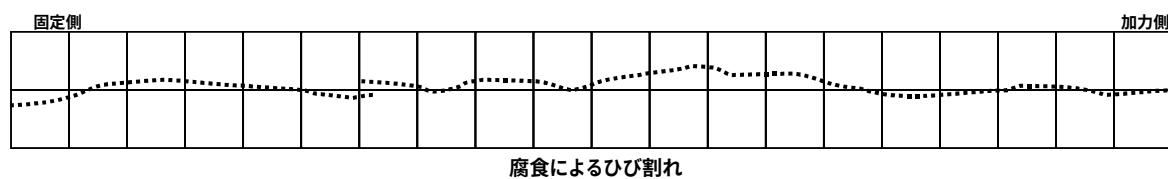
断面減少率10.2%試験体のひび割れ発生状況
